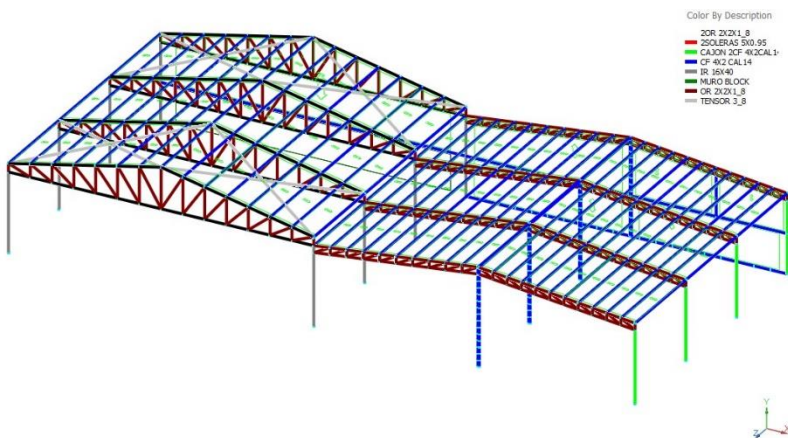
Secciones de Elementos Estructurales de la Nave del Estacionamiento
